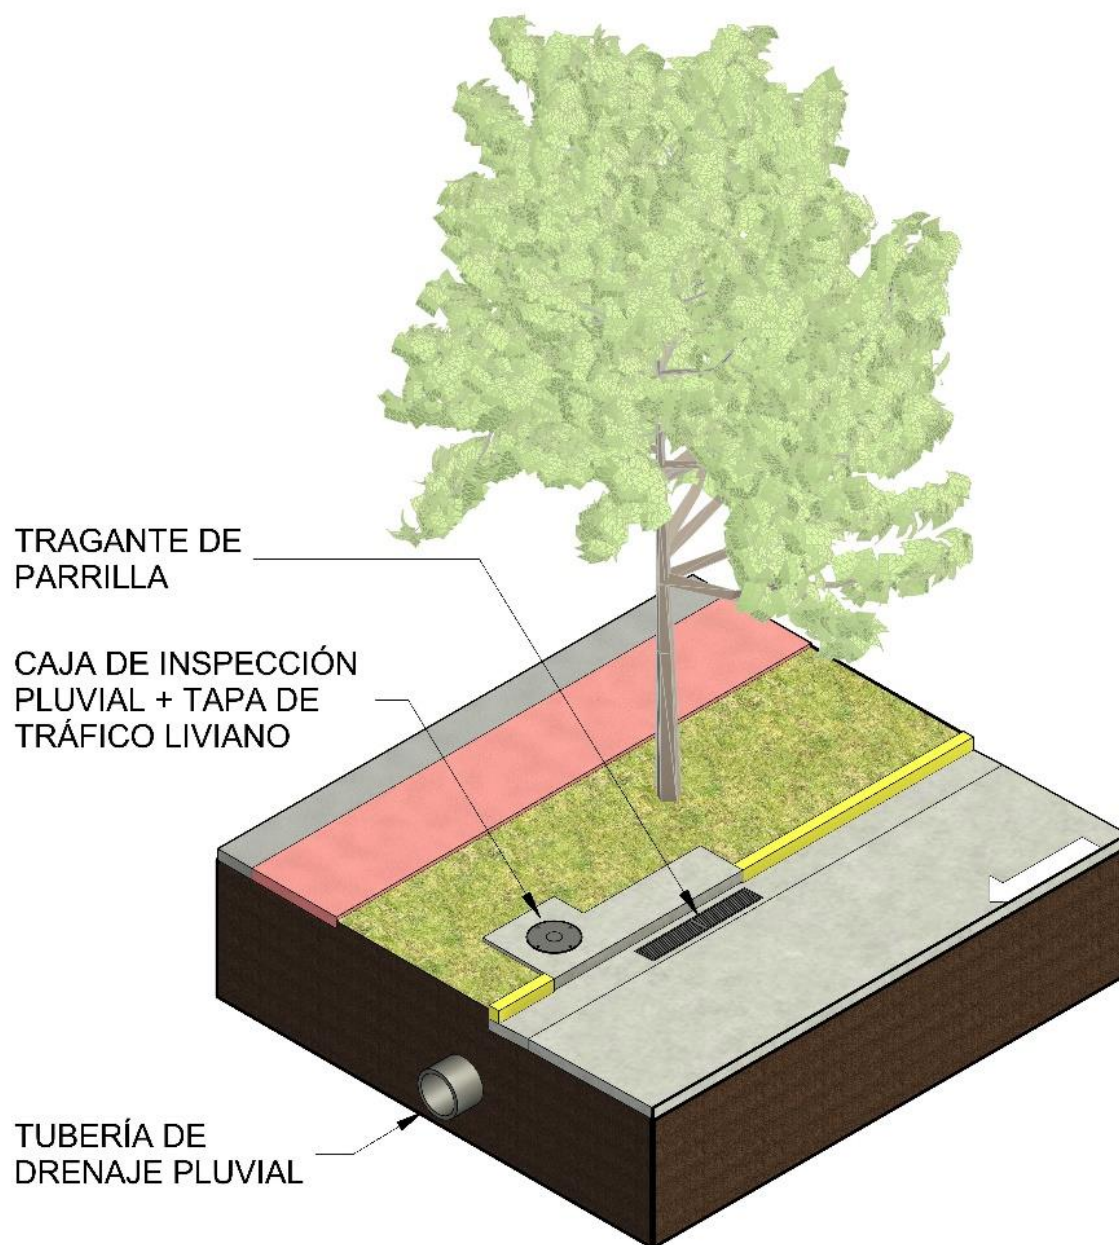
Detalle 3D de cámara de inspección, tragantes y alcantarillado pluvial | Elaborado por: El autor
